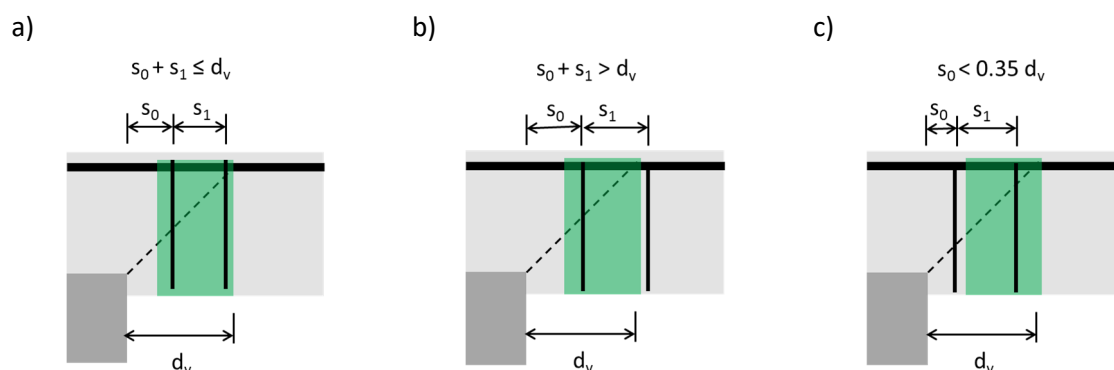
Diskrete Betrachtung der anrechenbaren Durchstanzbewehrung
